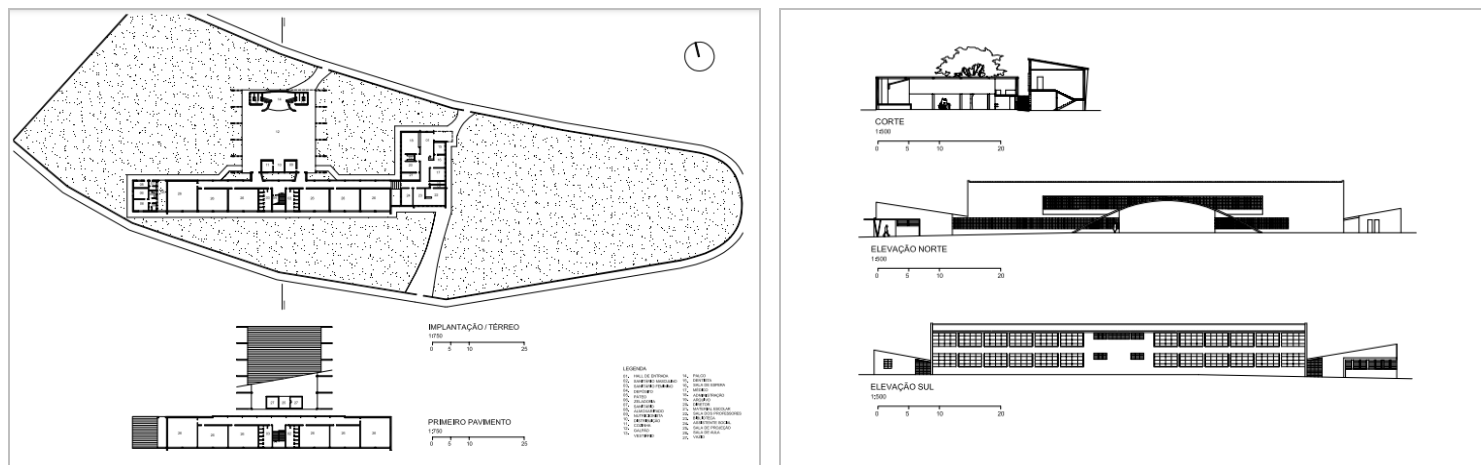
Planta e fachadas da E.E. Prof José Monteiro Boanova.
